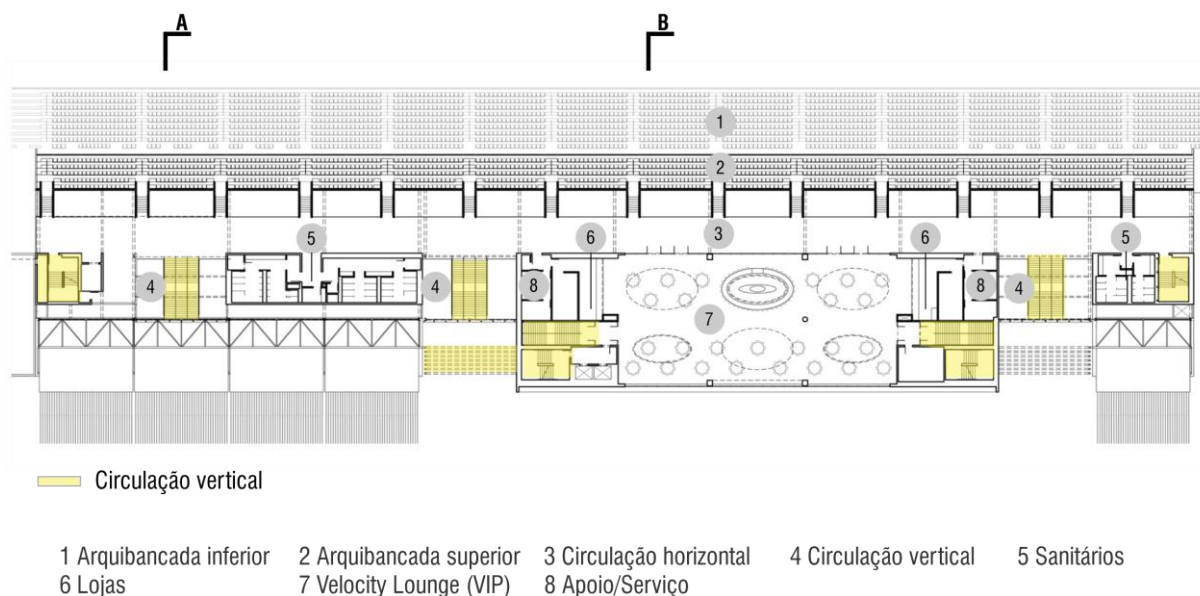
Planta baixa Arquibancada Principal - Nível 02
